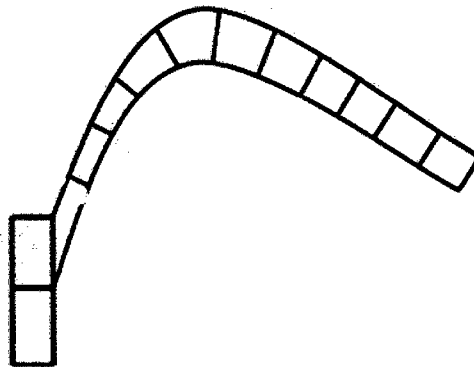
Sección Transversal de Modelo Estructura de Cáscara Gruesa de Elementos Sólidos.
